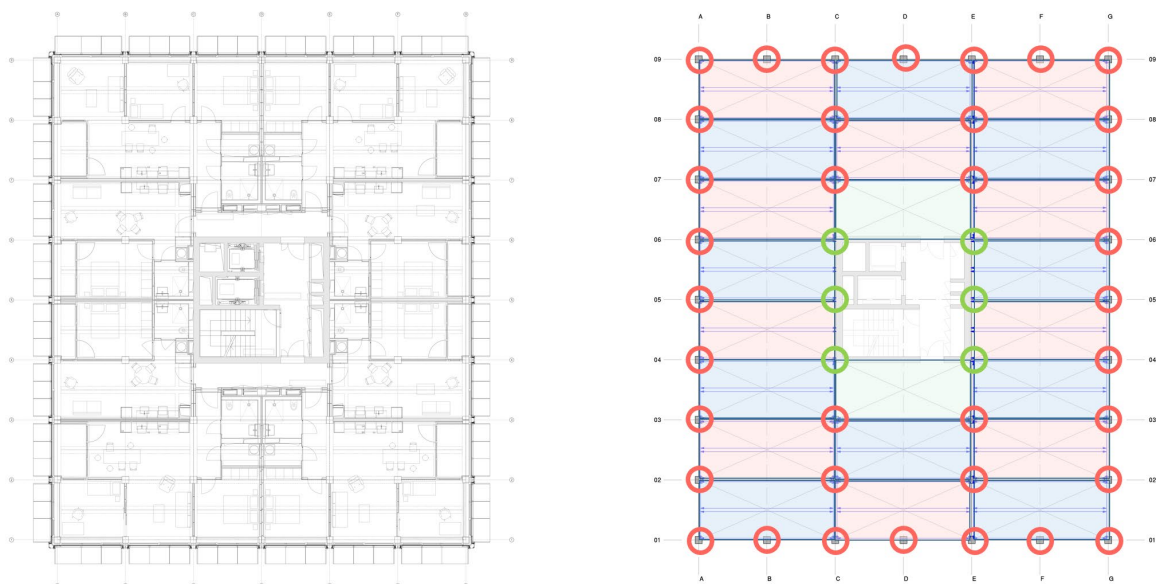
Architekturgrundriss Regelgeschoss (linkes Bild, Boltshouser Architekten AG) und Stützenraster (3.4 x 7.8 m) beziehungsweise Einteilung Deckenelemente
